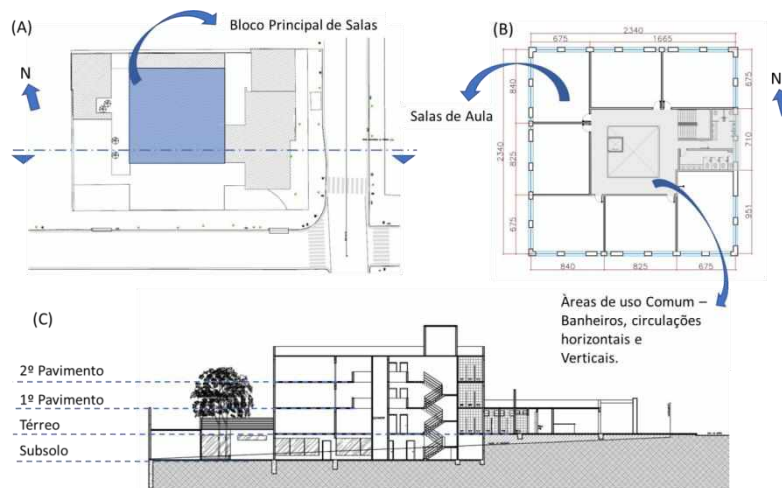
Síntese do projeto do edifício de ensino superior UnaLiberdade . (A) Planta de Situação, (B) Pavimento tipo bloco principal (térreo, 1º Pavimento e 2ºPavimento), (C) Corte do edifício.
